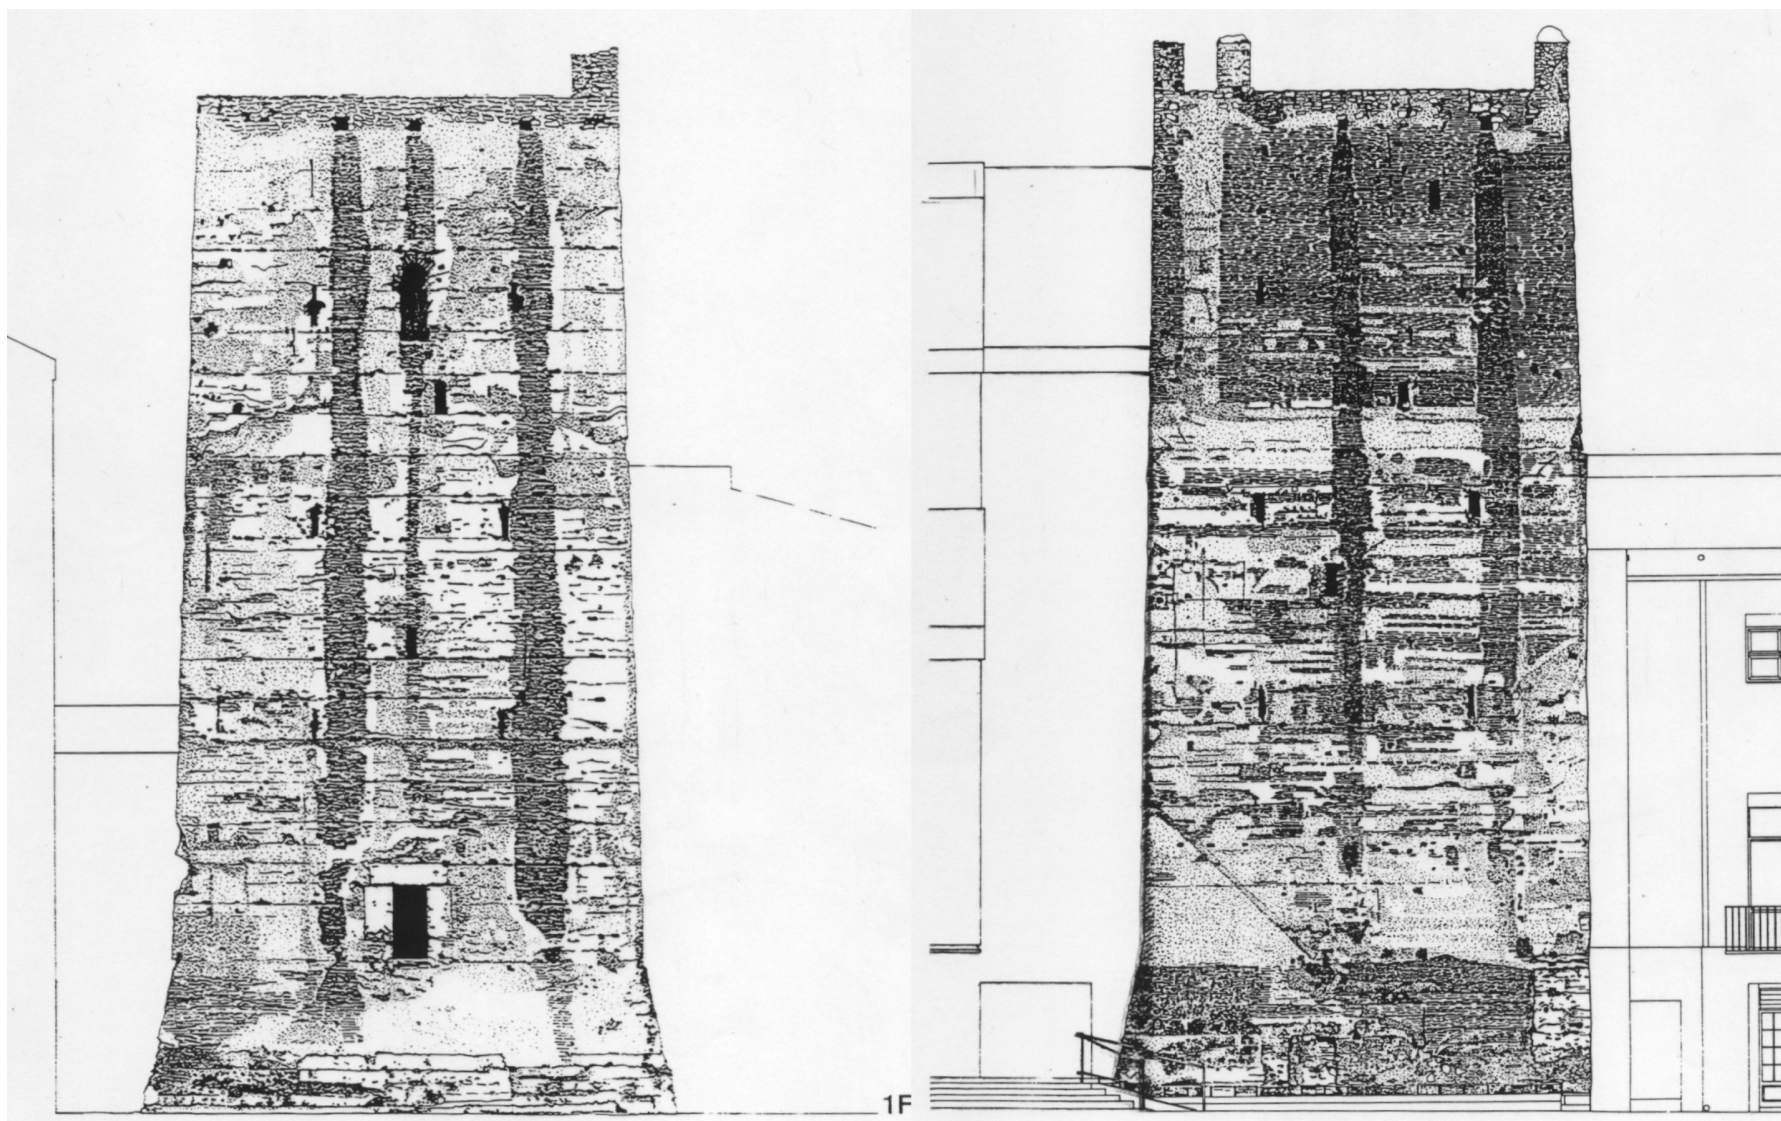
Estado anterior a la intervención. Alzados Sureste y Noreste. (Según Carmel Gradolí)
